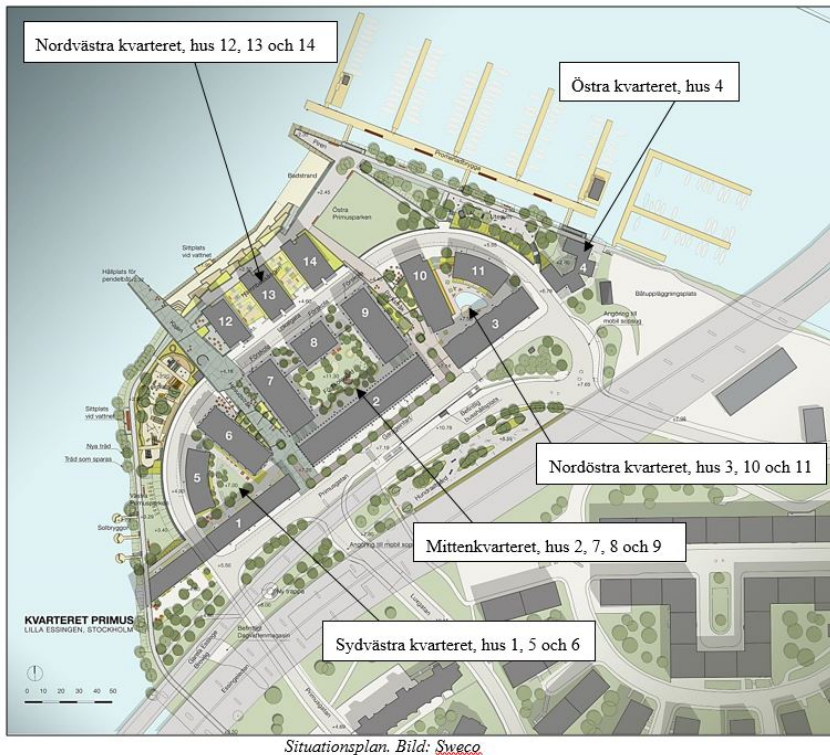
Situationsplan från detaljplan för Primus 1 mm, Dp 2006-05021
